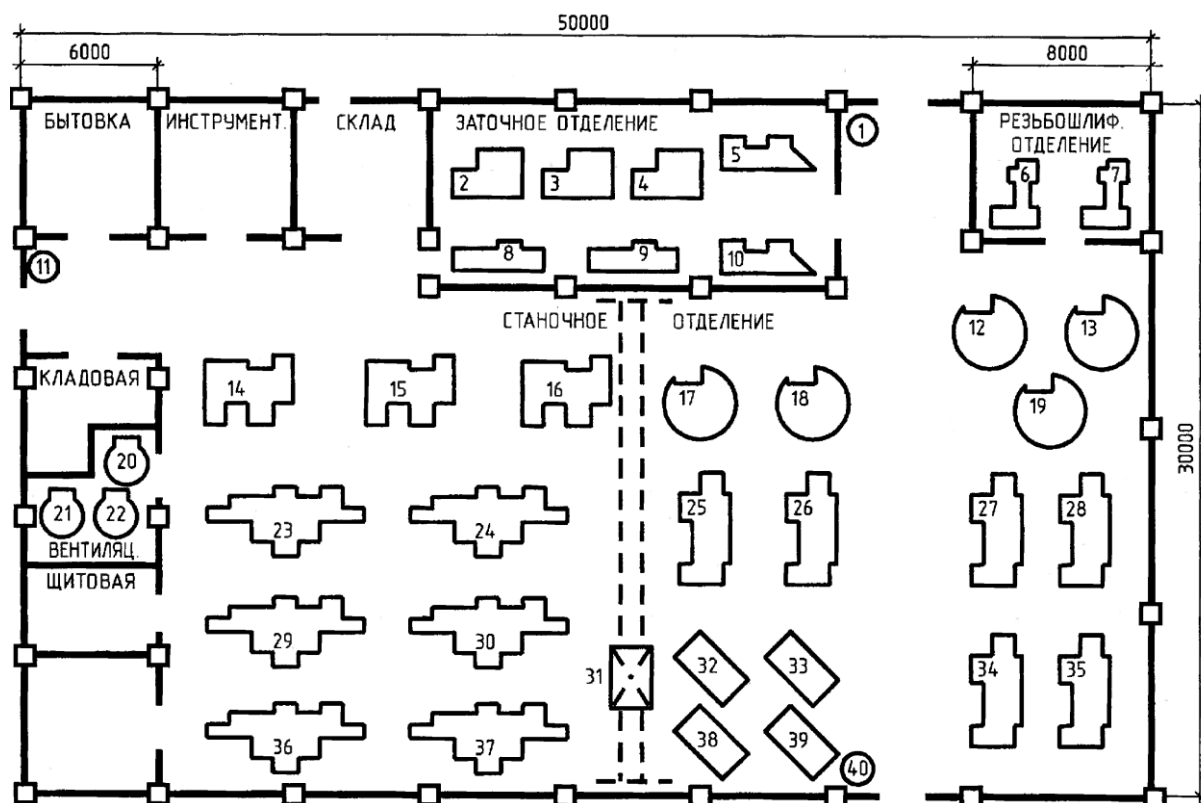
План расположения электрооборудования цеха металлорежущих станков
